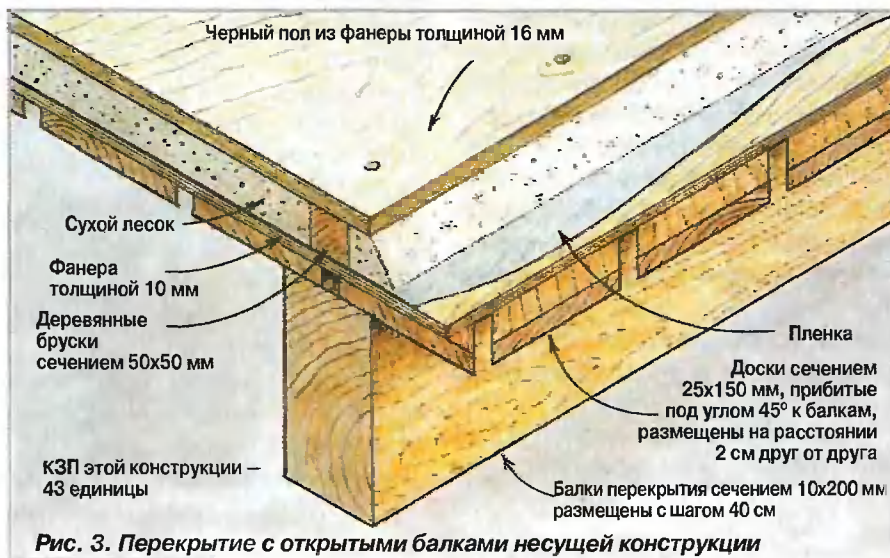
Перекрытие с открытыми балками несущей конструкции
